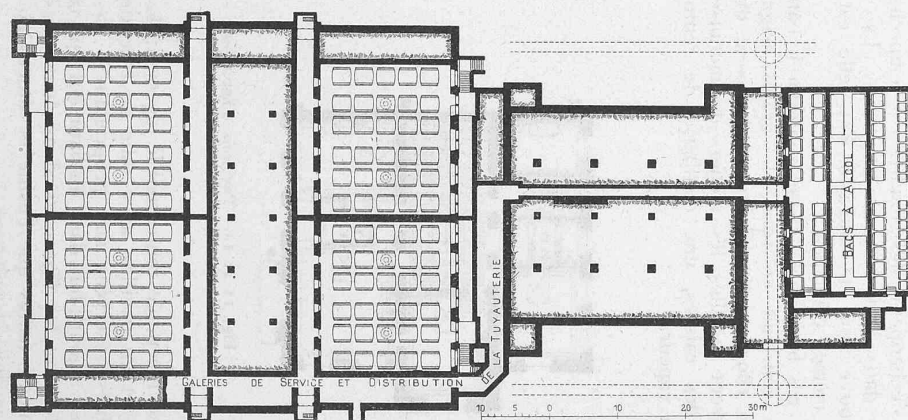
Plan du sous-sol. — Echelle 1 : 1000.
